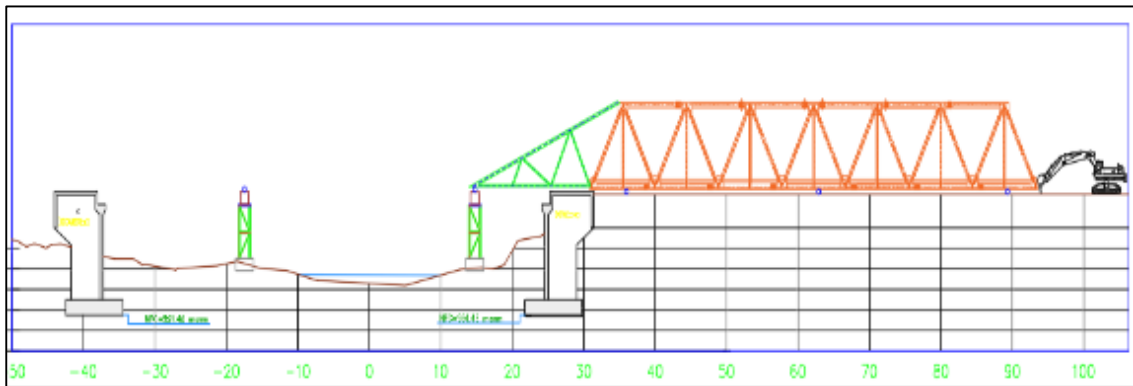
Etapa de fabricación in situ de la nariz de lanzamiento.
